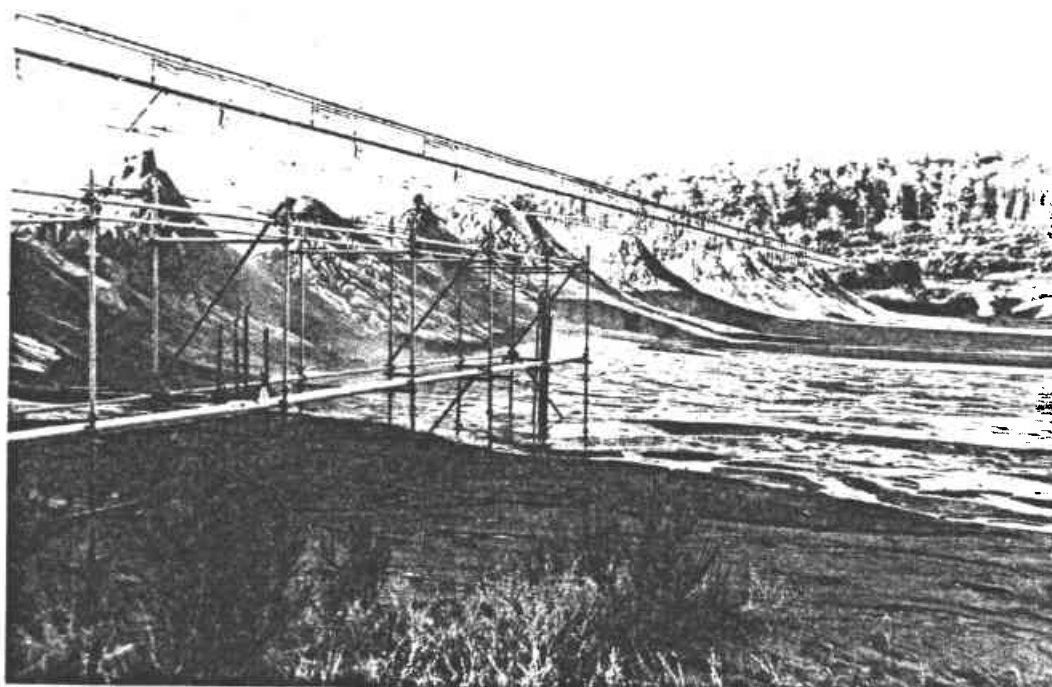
Installation de cyclonage au droit de la digue (vue côté amont). Station de mesures n° 1 et 2 au premier plan.
